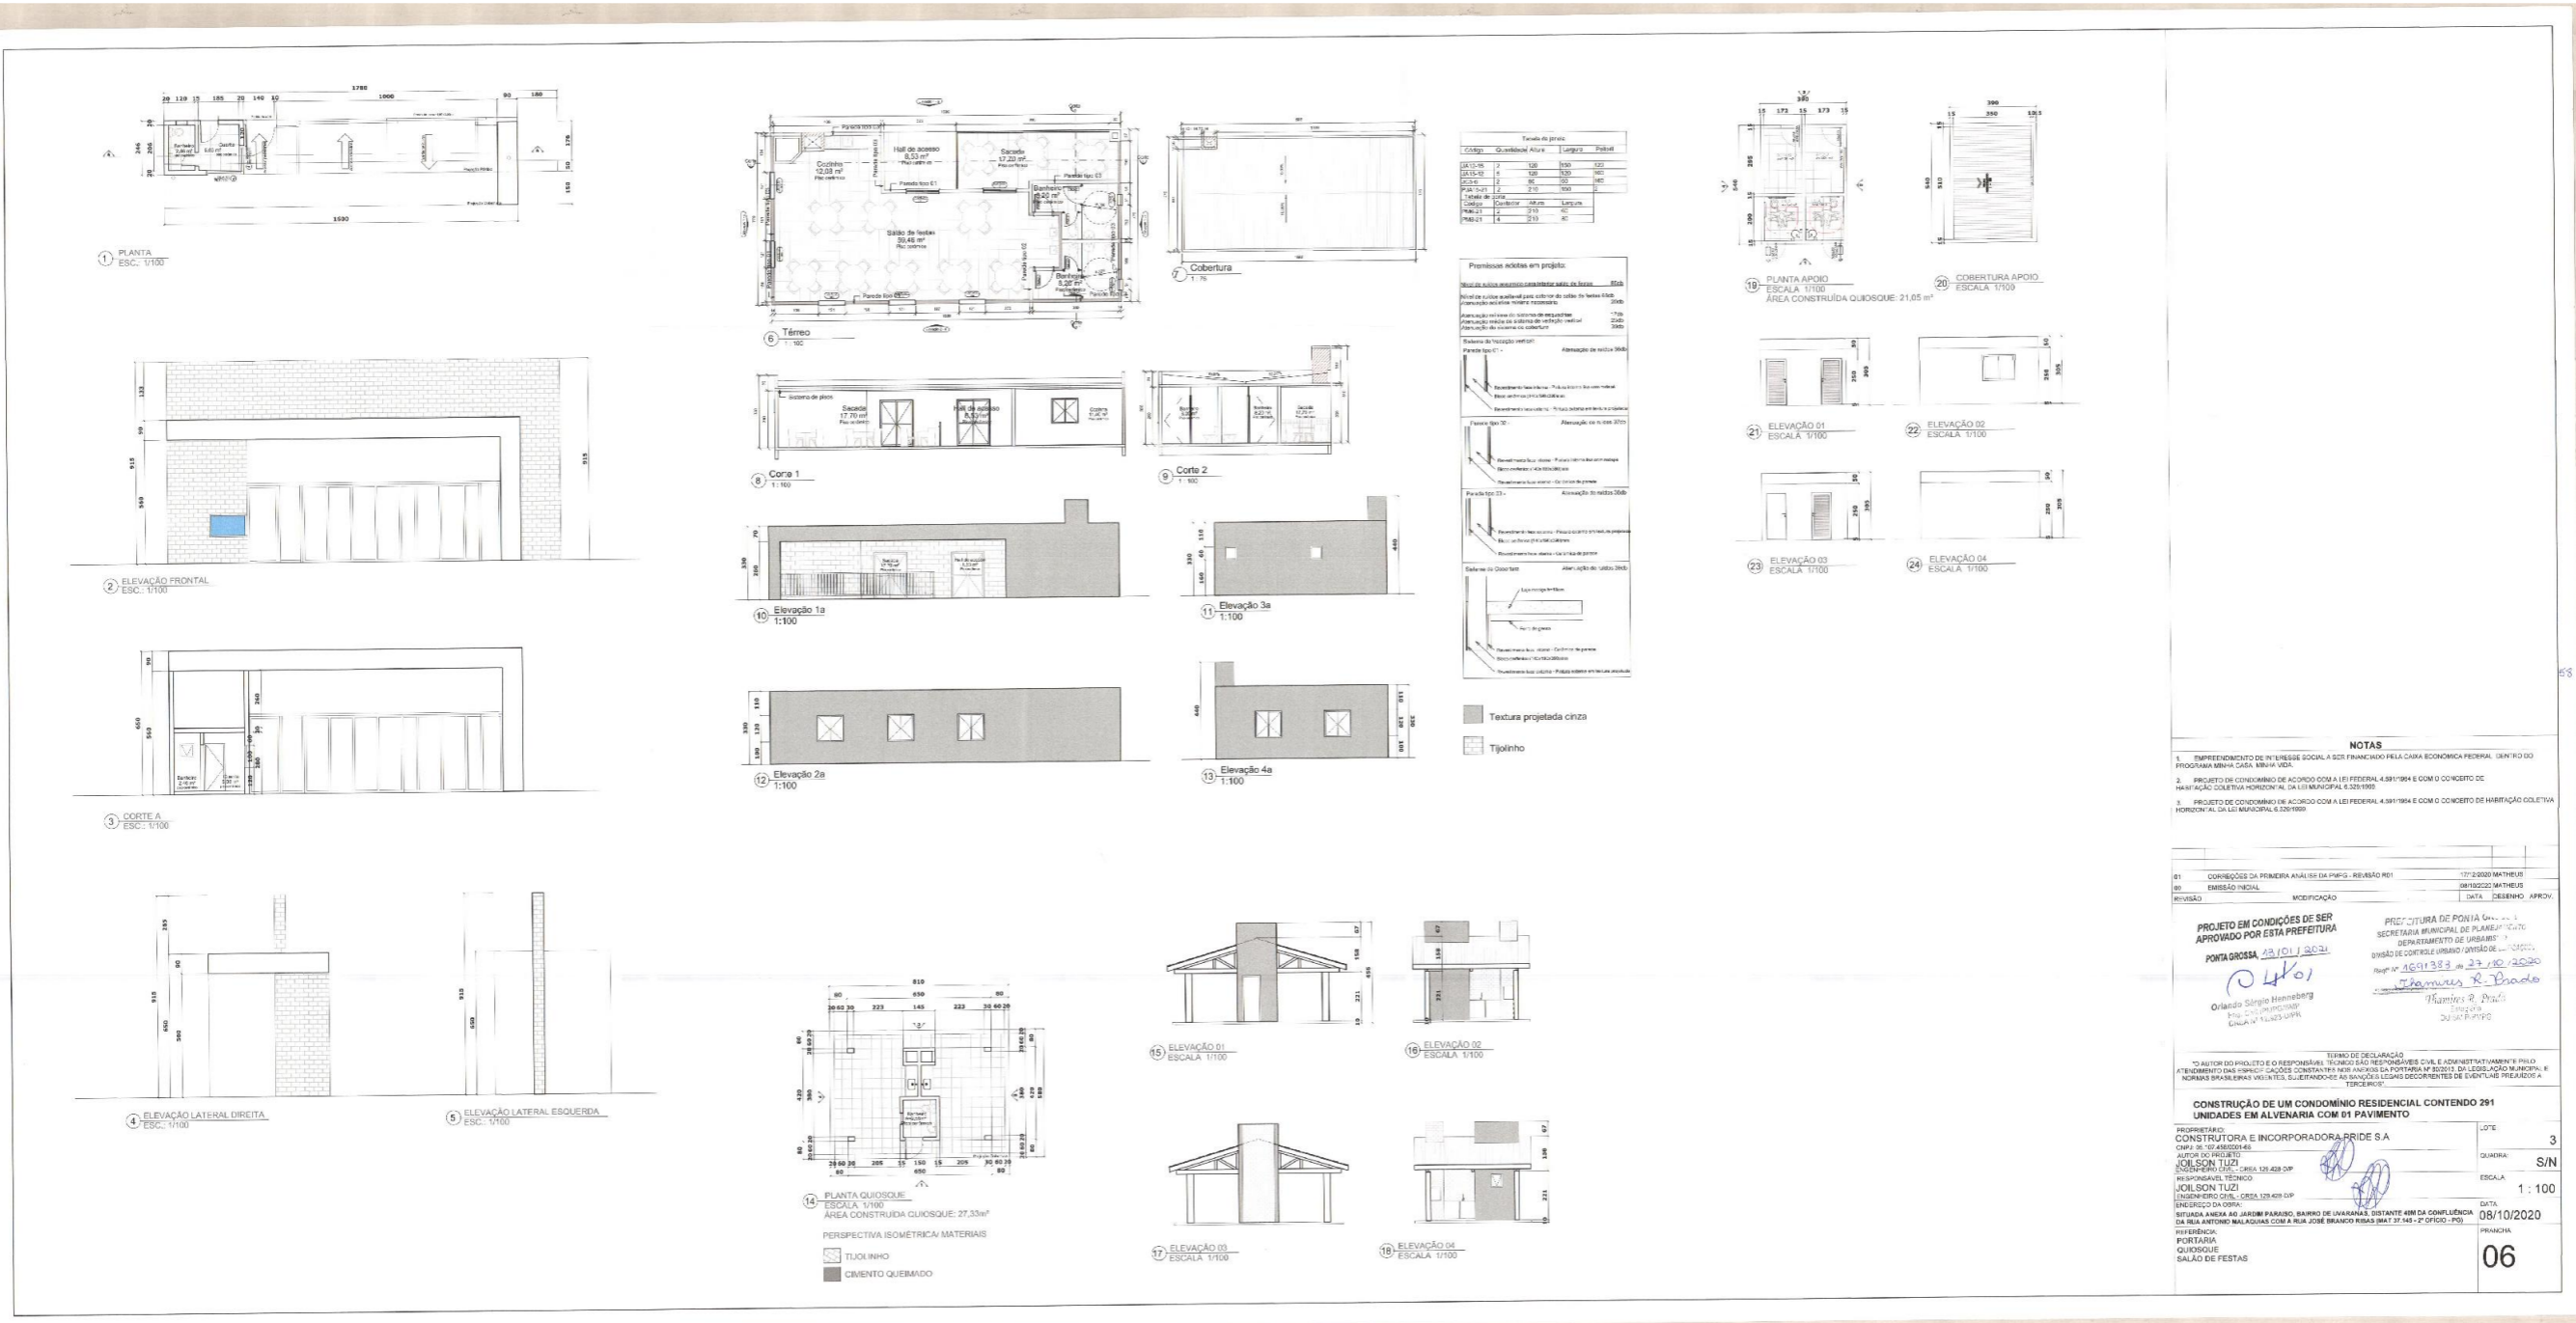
Projeto Arquitetônico – Condomínio Residencial Otto 1 – Planta 06.
